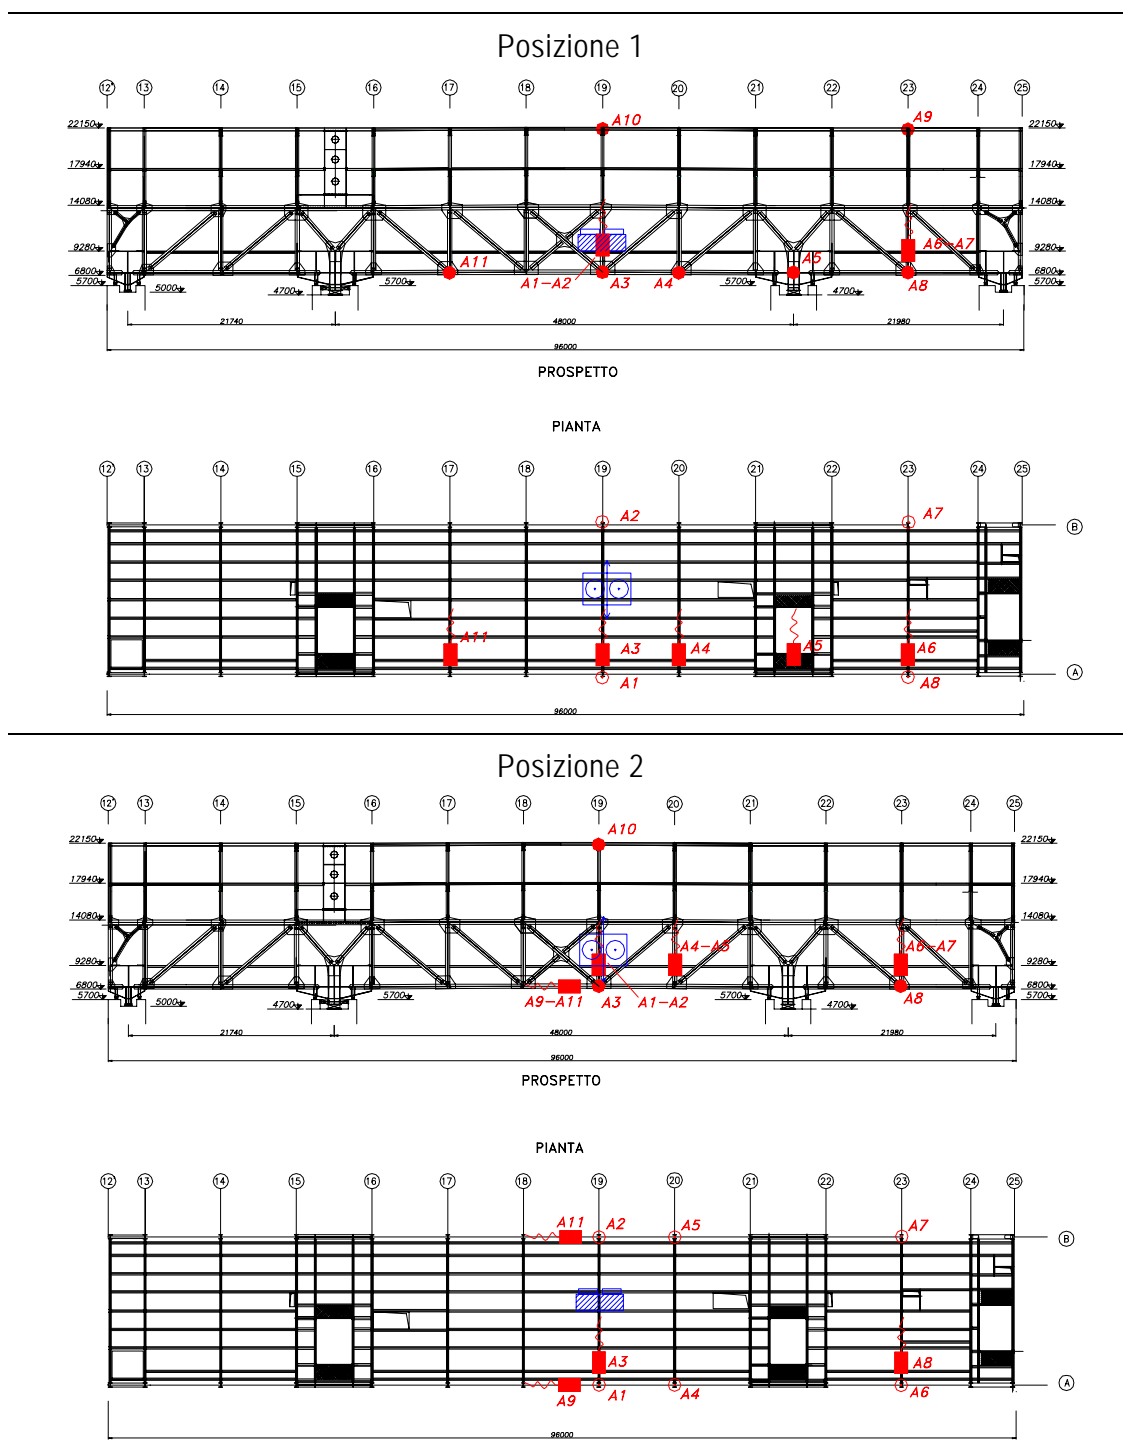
Schema dello scavalco e disposizione degli strumenti nelle Posizioni 1 e 2.
